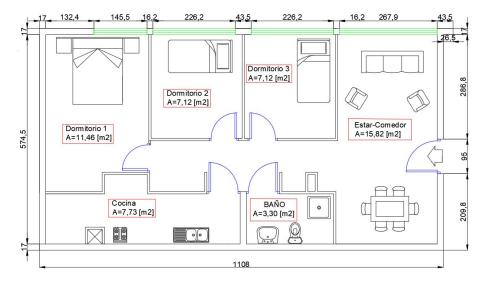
Planta arquitectura departamento Villa Jaime Eyzaguirre replicada en AutoCAD. Fuente: Elaboración propia.
